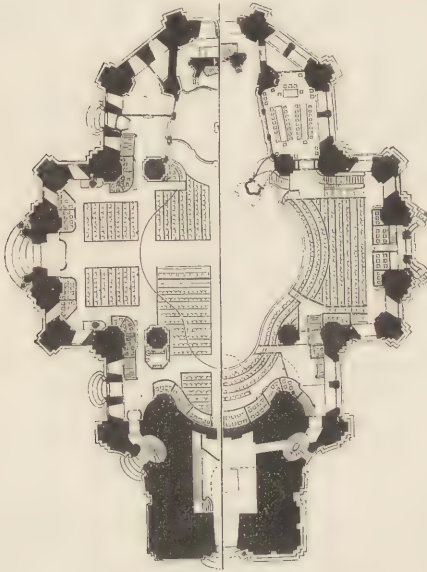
Michaeliskirche zu Hamburg. Grundriss des Erd- und Obergeschoßes.
